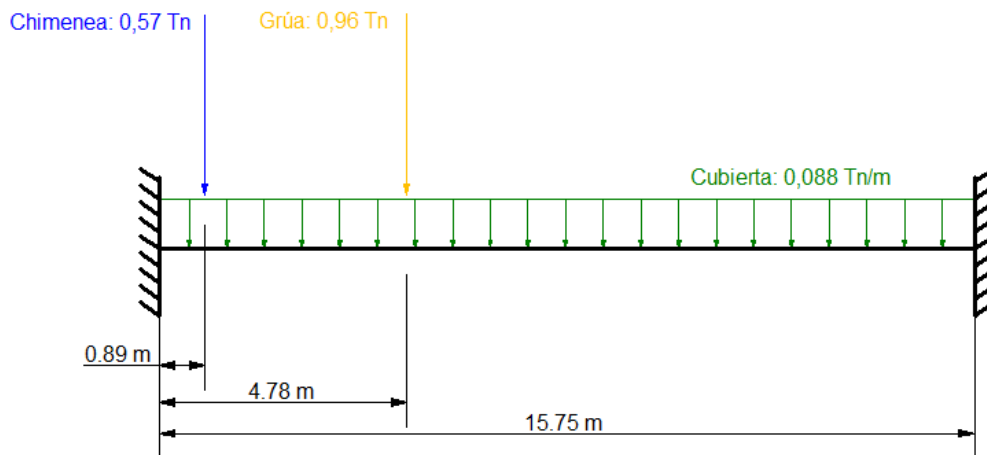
Esquema de la situación idealizada de la viga hiperestática sometida a las diferentes cargas
